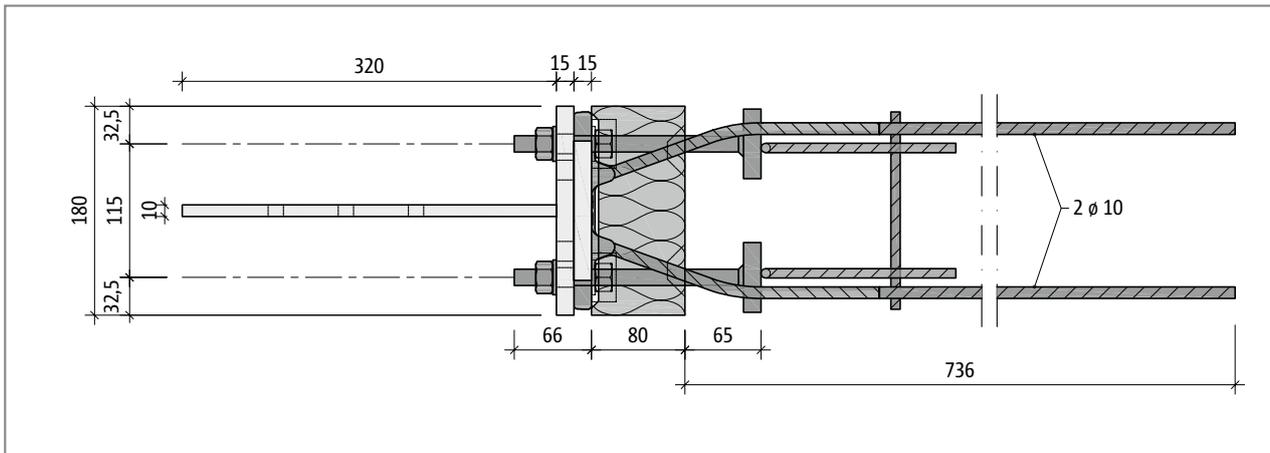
Schöck Isokorb® T Typ SQ mit Stahlschwert: Grundriss
